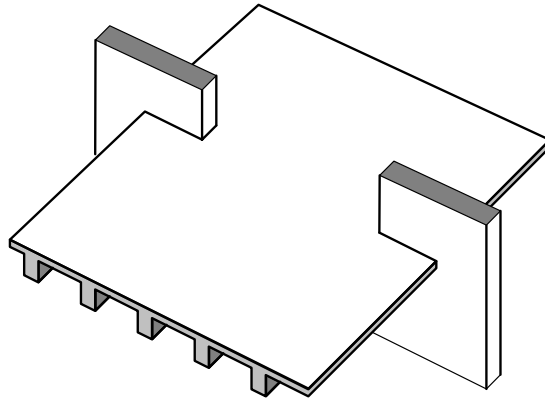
Carga vertical sobre una viga con zonas rígidas
